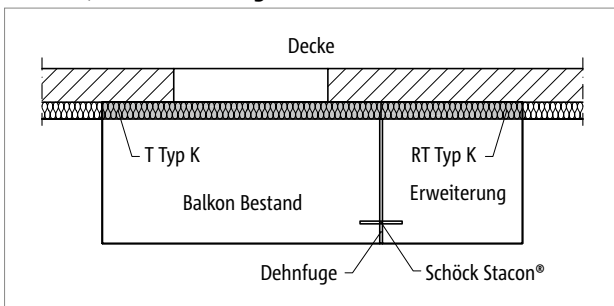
Schöck Isokorb® RT Typ K, Schöck Isokorb® T Typ K: Balkon frei ausragend mit direkter Lagerung bei Erweiterung eines Bestandsbalkons
